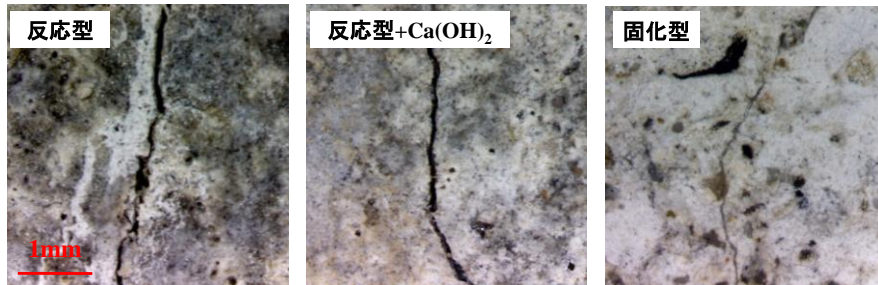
ひび割れ部の拡大写真（塗布後 28 日）
